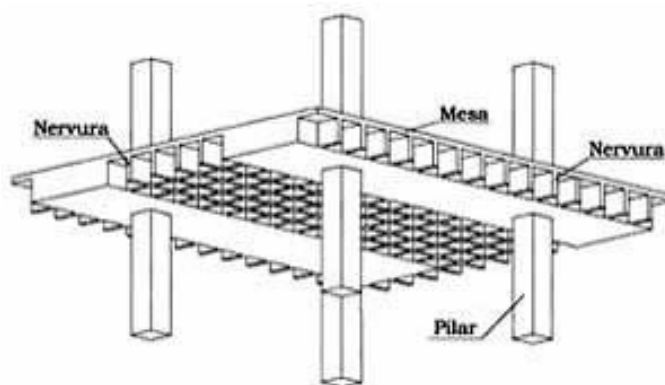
Esquema da laje nervurada com pilares (ALMEIDA FILHO, 2002)
